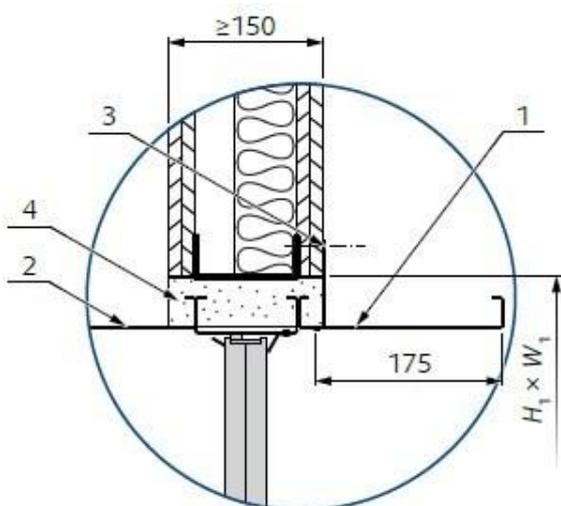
(EI120S) Sezione trasversale per installazione a umido in parete flessibile
